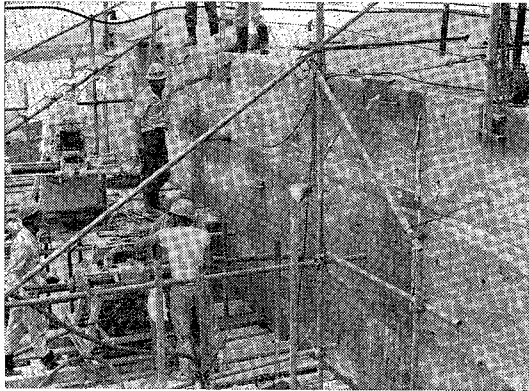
北口からの水平縫地 RC ボルト工の作業状況
